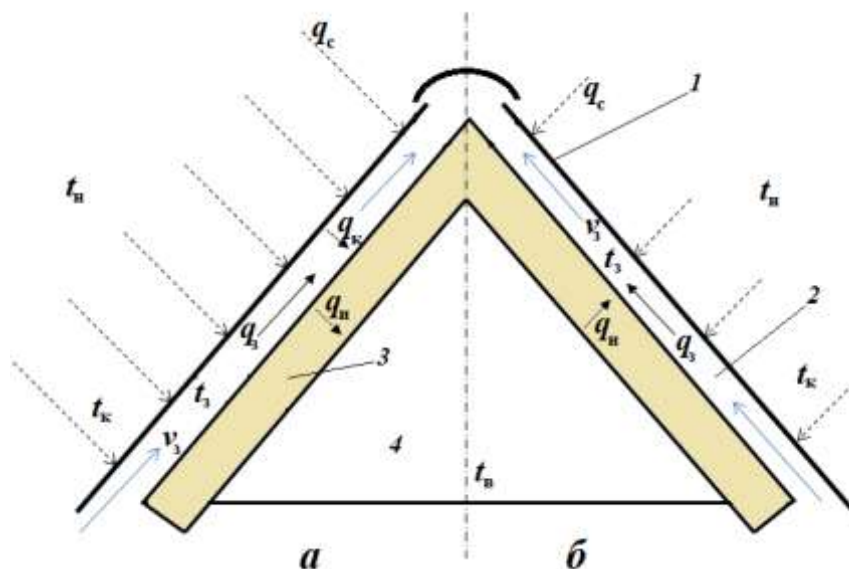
Схема теплообмена в скатной кровле (ветрозащита и пароизоляция не показаны): а — жаркое лето; б — зима; 1 — металлическое кровельное покрытие; 2 — вентиляруемый зазор; 3 — теплоизоляция; 4 — подкровельное пространство; q_c — поток тепла от солнца; q_k — поток тепла от металлической кровли; q_n — поток тепла через слой изоляции; q_3 — конвективный поток тепла в вентиляруемом зазоре; t_n — температура наружного воздуха; t_k — температура на поверхности кровли; t_3 — температура воздуха движущегося в зазоре; t_b — температура внутреннего воздуха; v_3 — скорость воздуха в вентиляруемом зазоре
